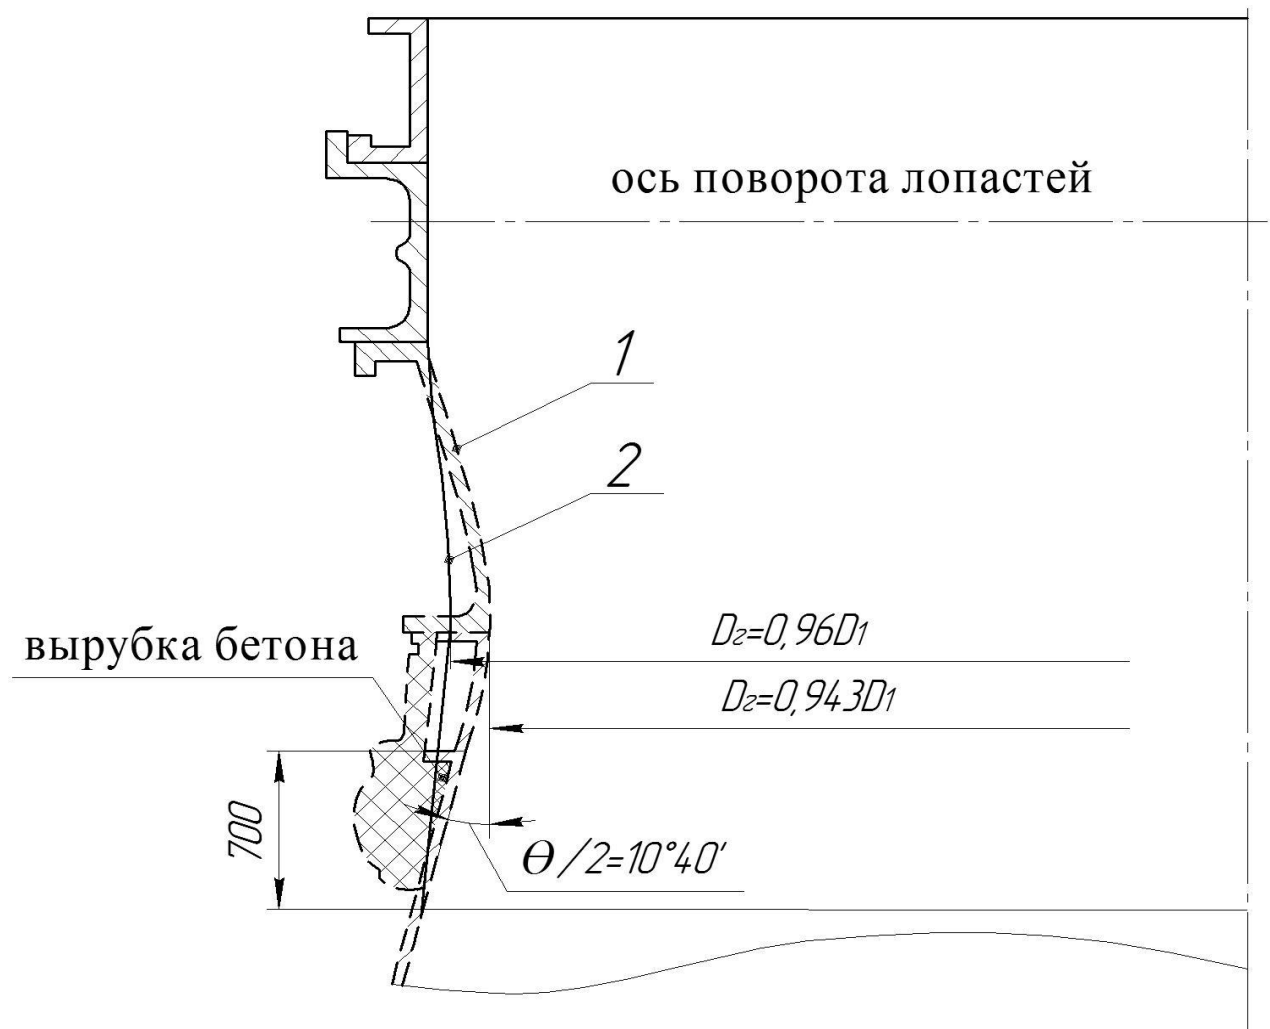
Реконструкция камеры рабочего колеса:
